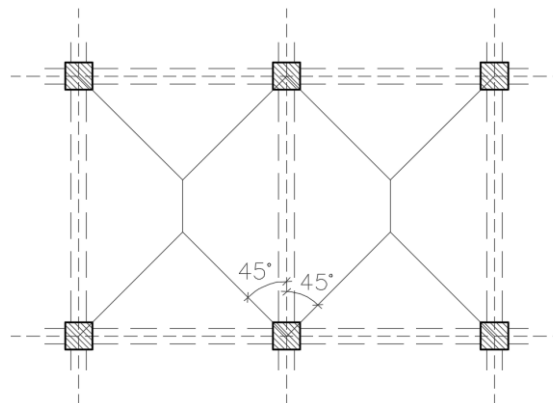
Área tributaria para cálculo del cortante en una viga interior.
